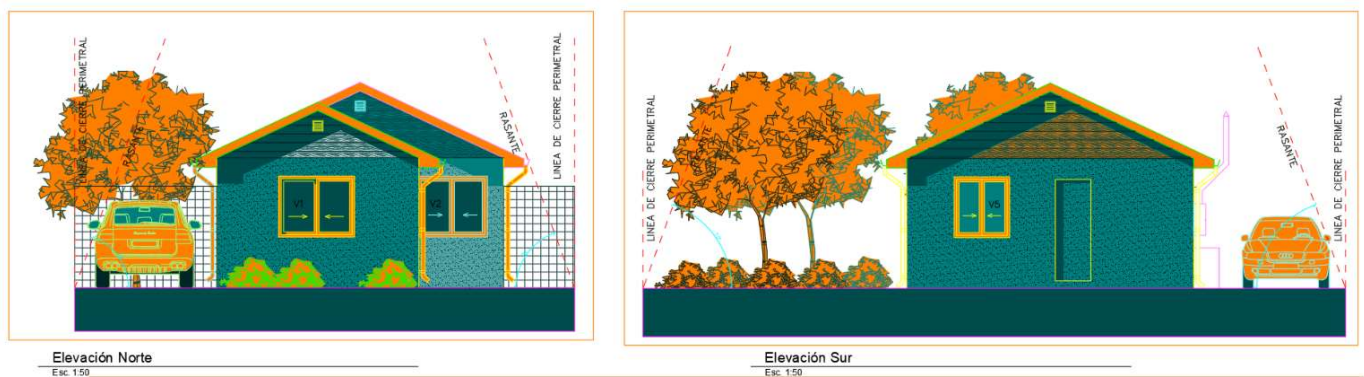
Elevación Norte y Sur - Vivienda Objeto
